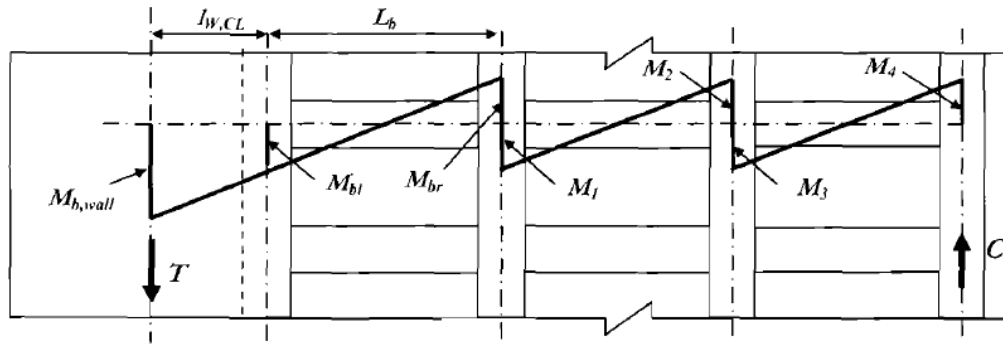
Incremento de momentos en muros con las vigas conectadas; Fuente: (Priestley, Calvi, & Kowalsky, 2007)
